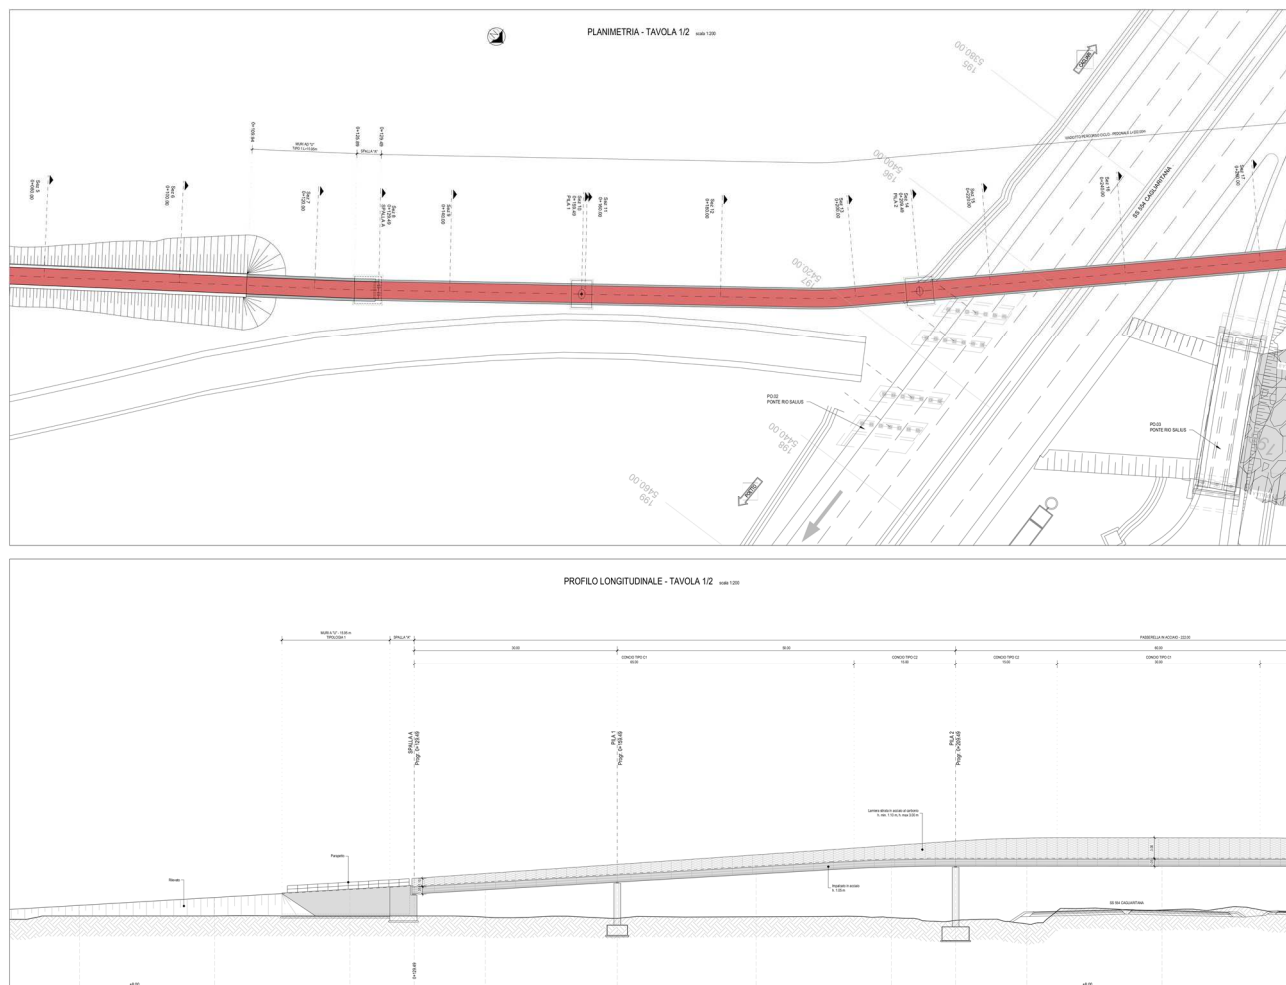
Pianta e prospetto del ponte (1 di 2)
